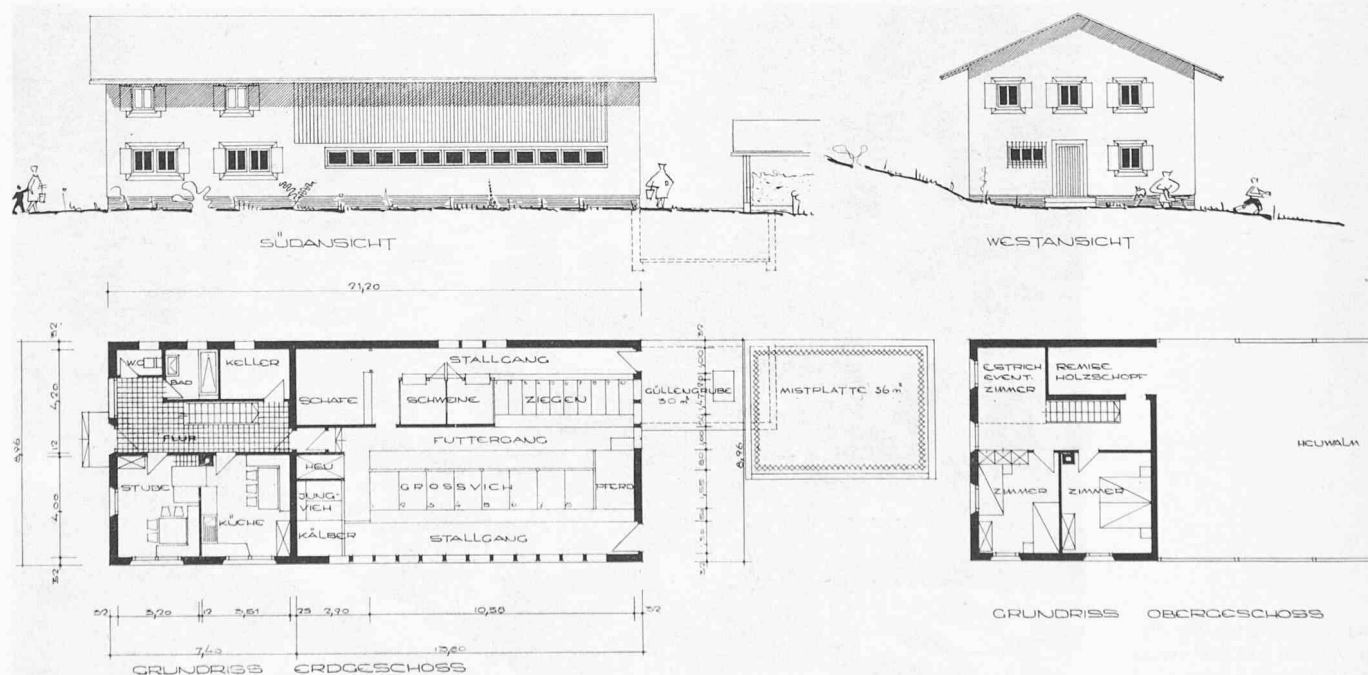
Wintergehöfte Susauna im Engadin, Grundrisse einer Einheit, Masstab 1:300
